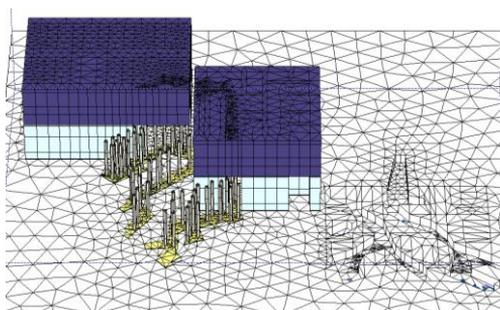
Расчетная схема (2-й этап моделирования)
